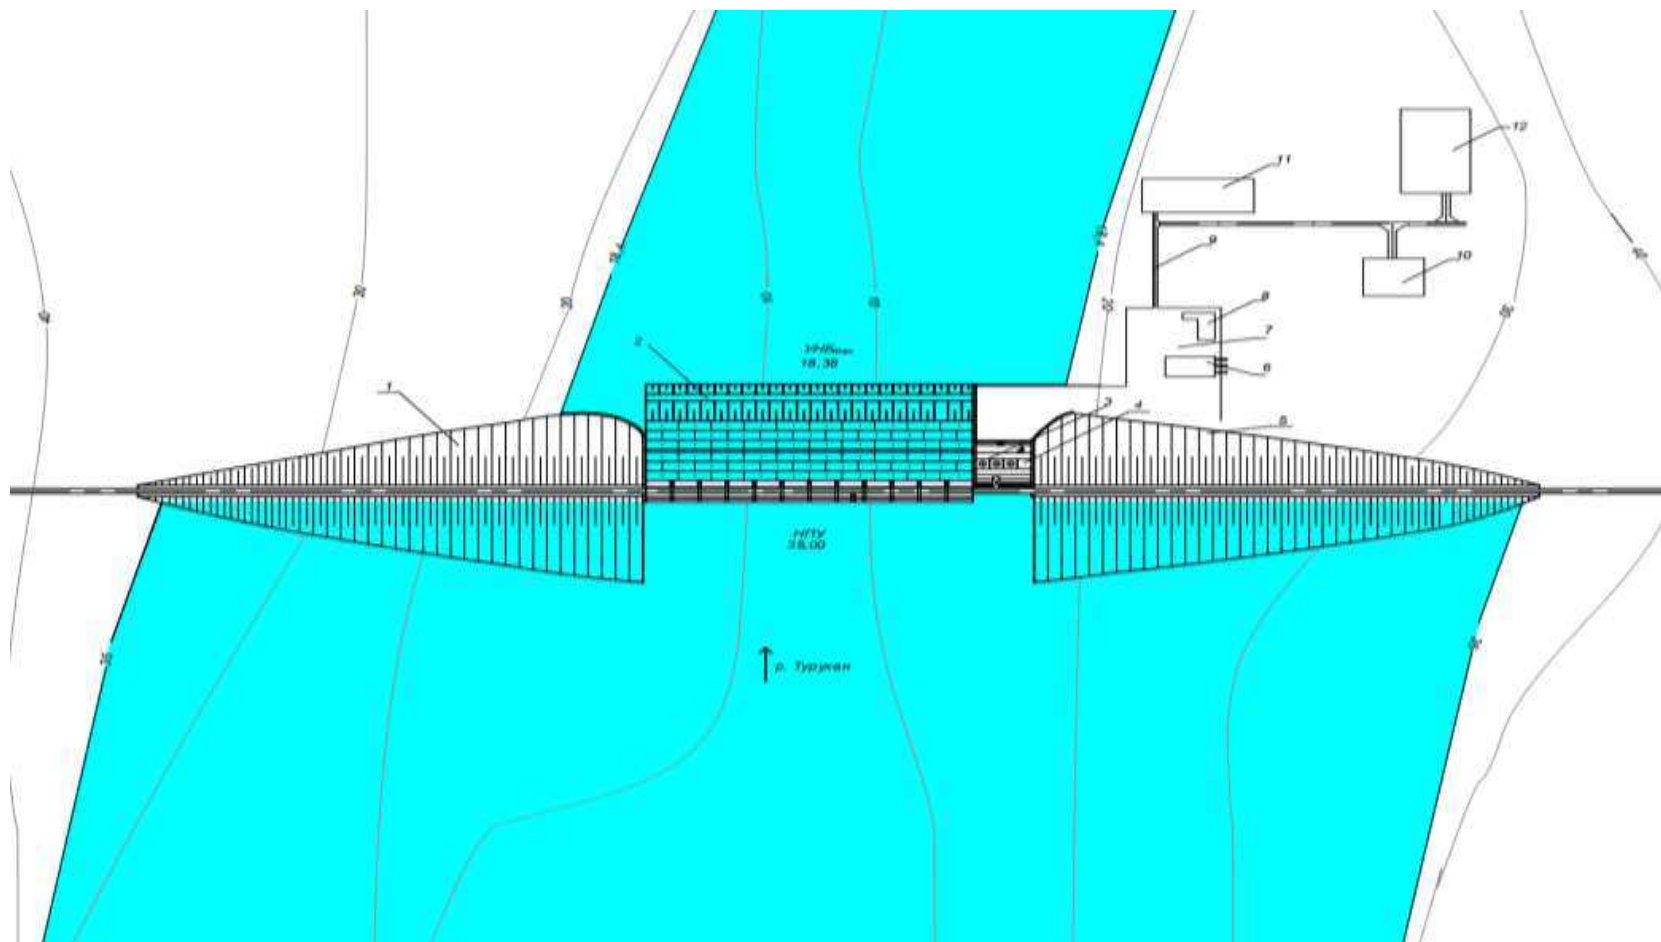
Строительный генеральный план Турейской ГЭС
